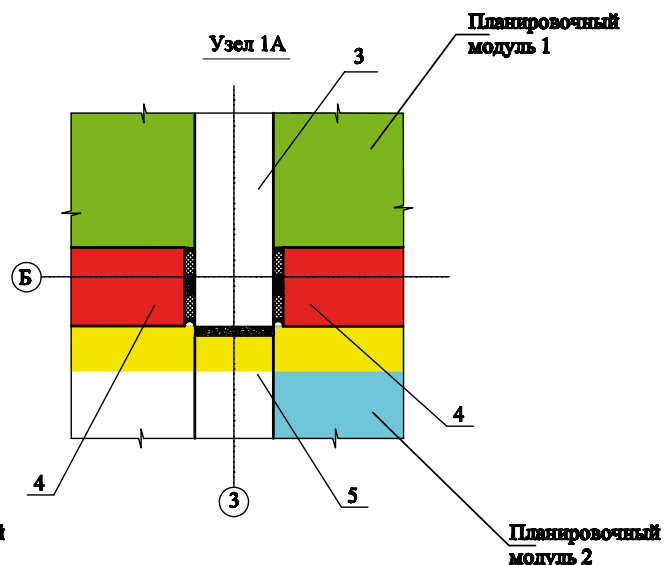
Модернизированный узел примыкания наружных стен к внутренним
